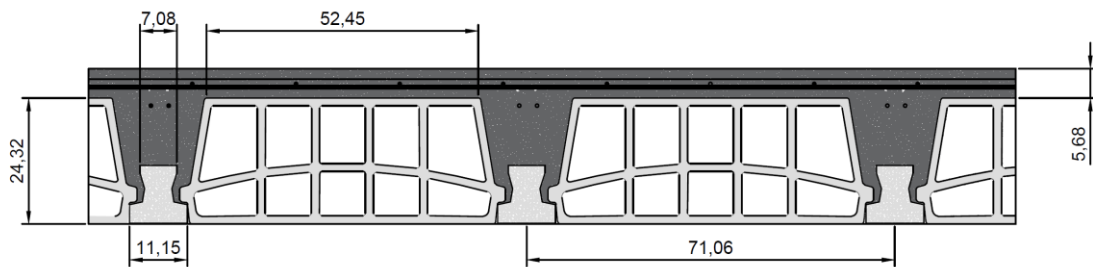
Croquis acotado de la sección del forjado. (Fuente: elaboración propia)
